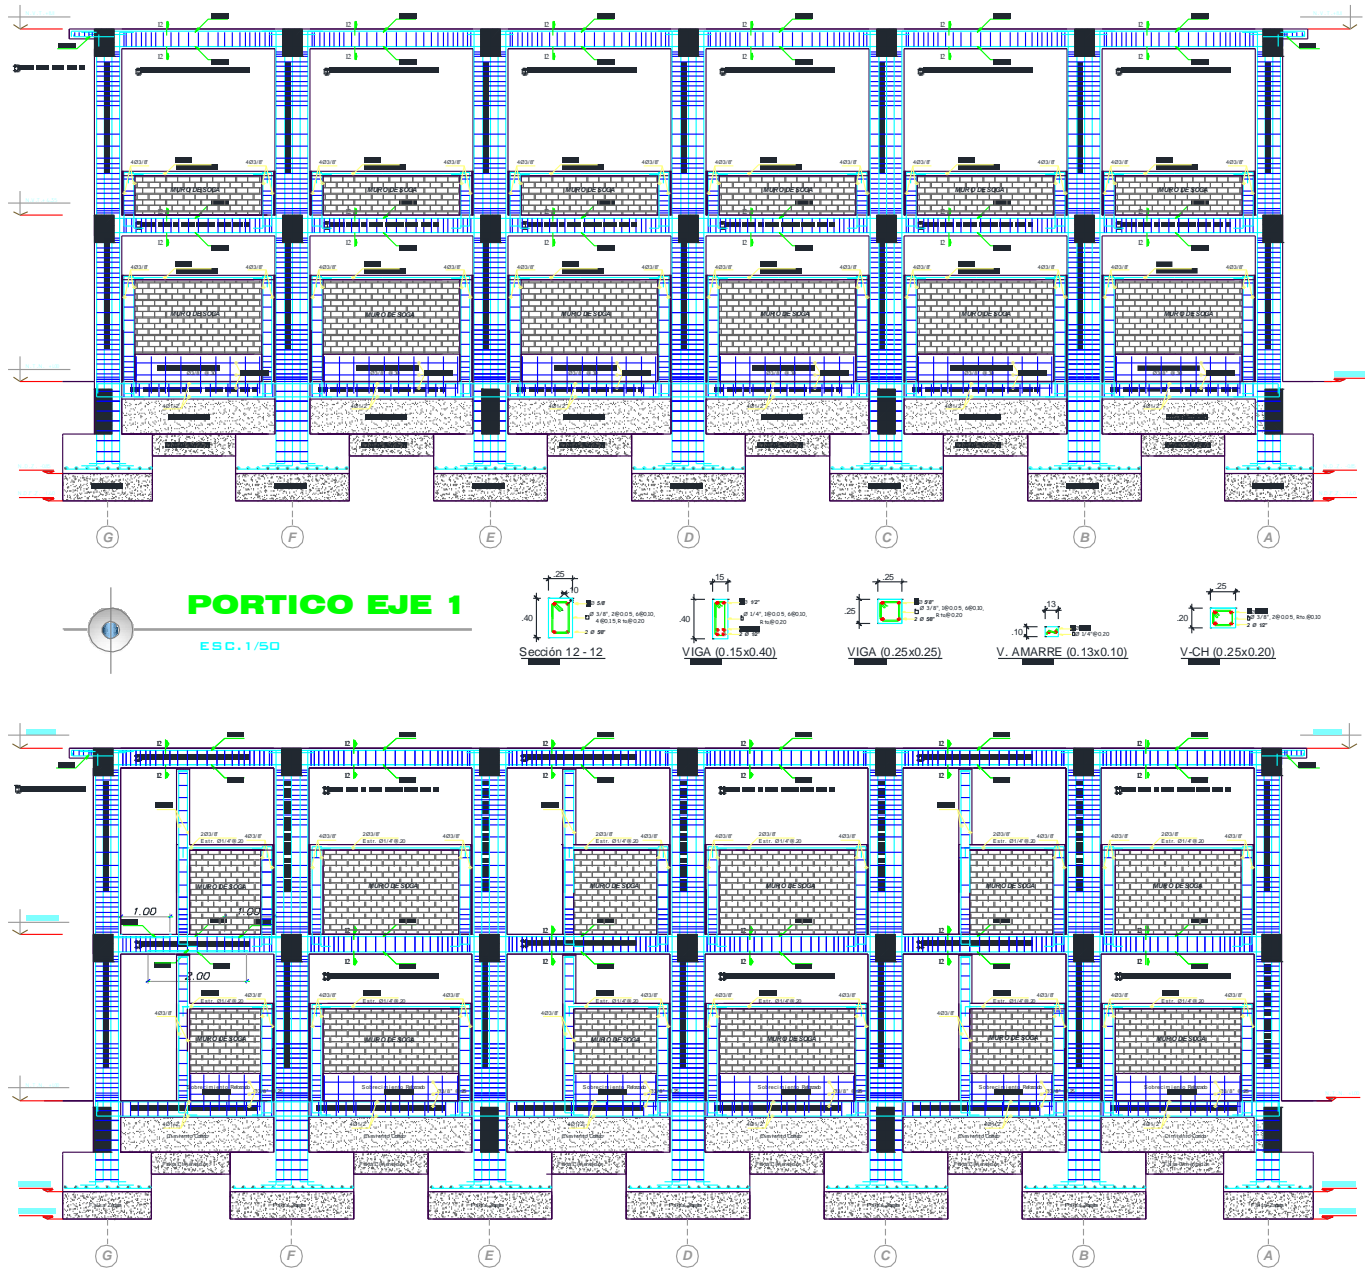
Detalle de Vigas y Pórticos Transversales
